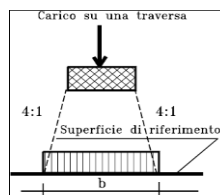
Distribuzione longitudinale dei carichi attraverso il ballast.
